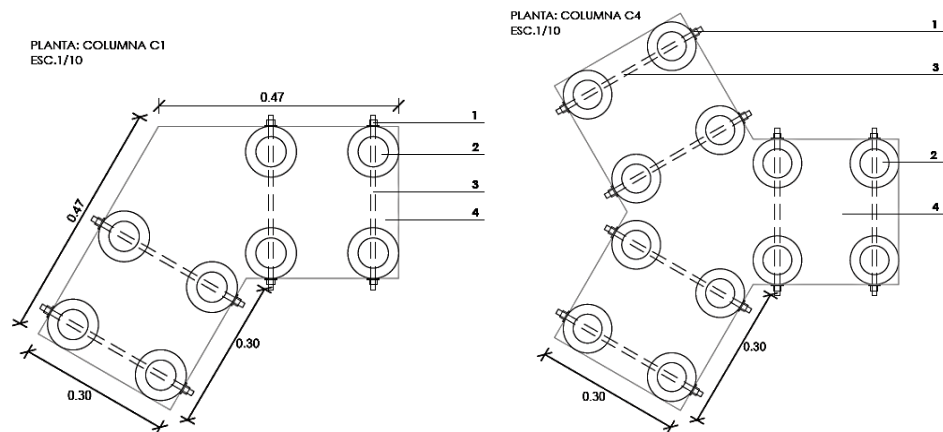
Planta de columnas principales: “L” y “Y”. Fuente: Elaboración propia.
